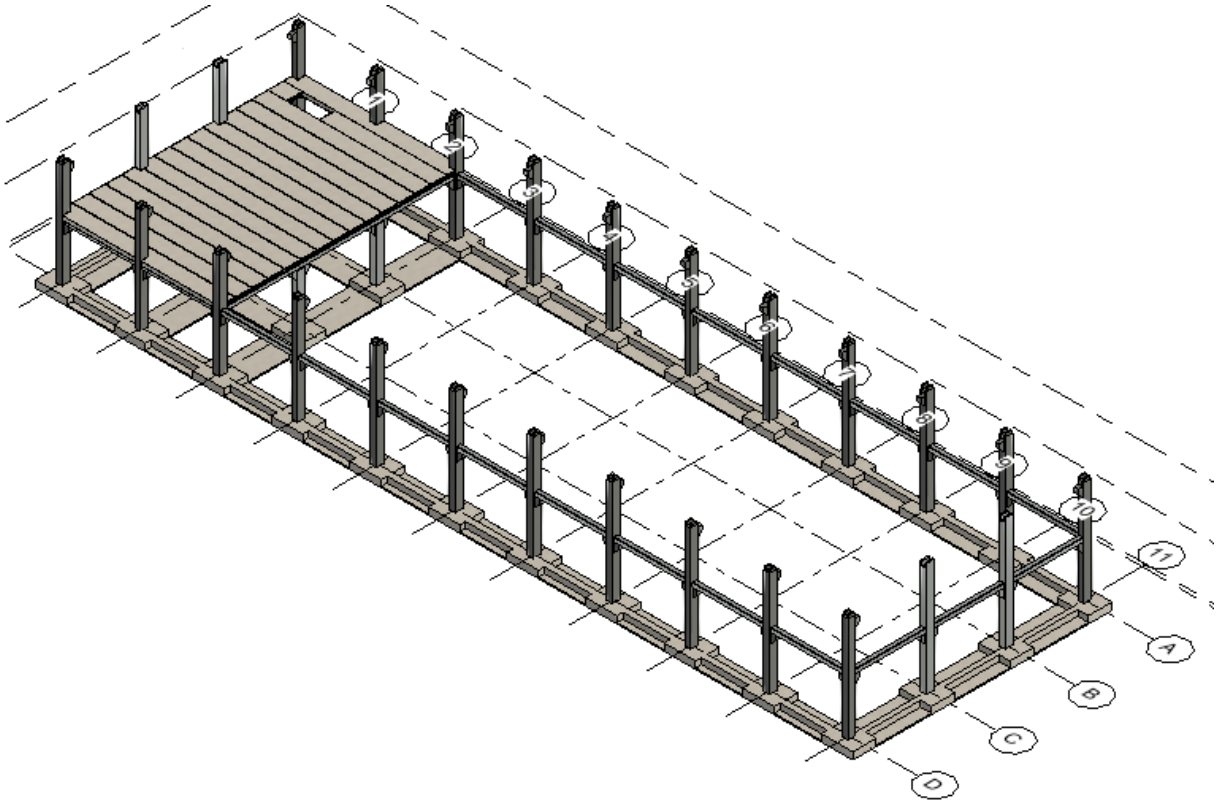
Col·locació de les plaques alveolars. (Font: "Revit")
